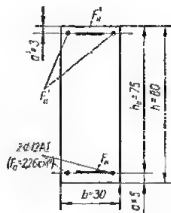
Схема расположения арматуры в сечении предварительно напряженной железобетонной балки.
